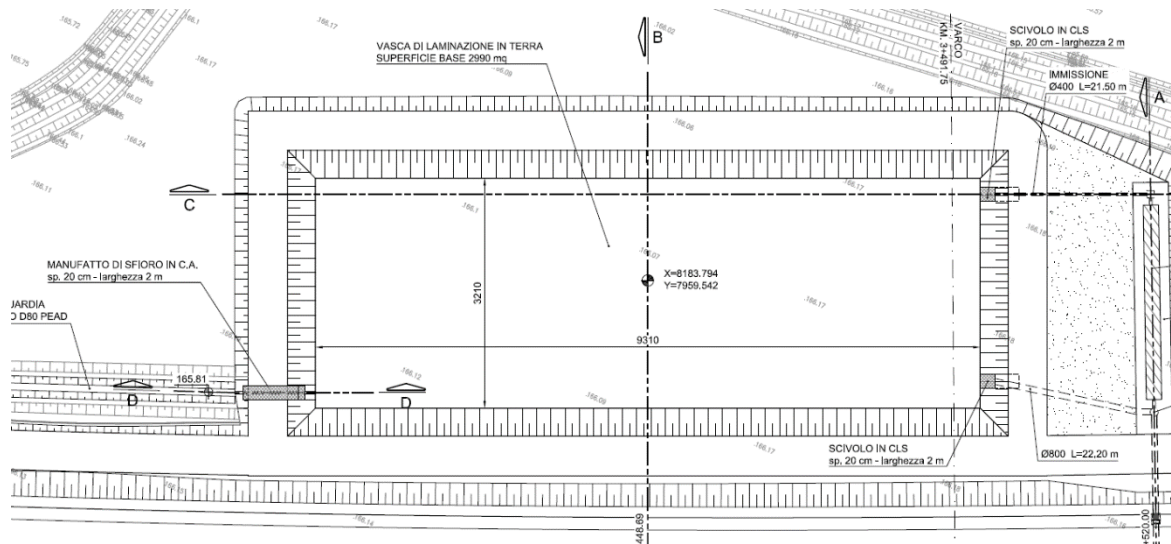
planimetria generale dell'impianto di laminazione C
